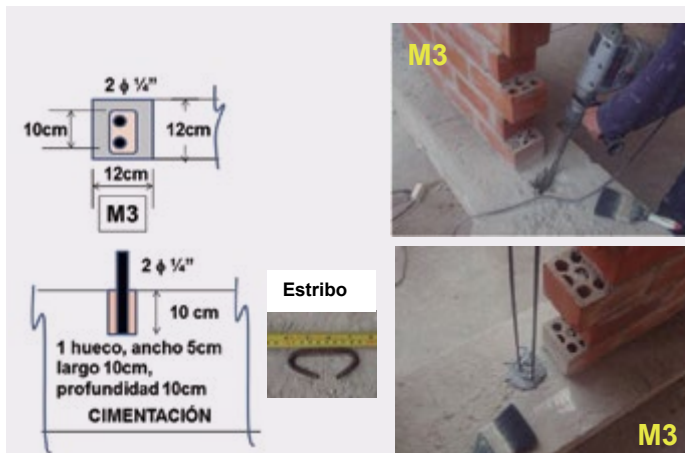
Refuerzo y anclaje en columnas del parapeto M3.
